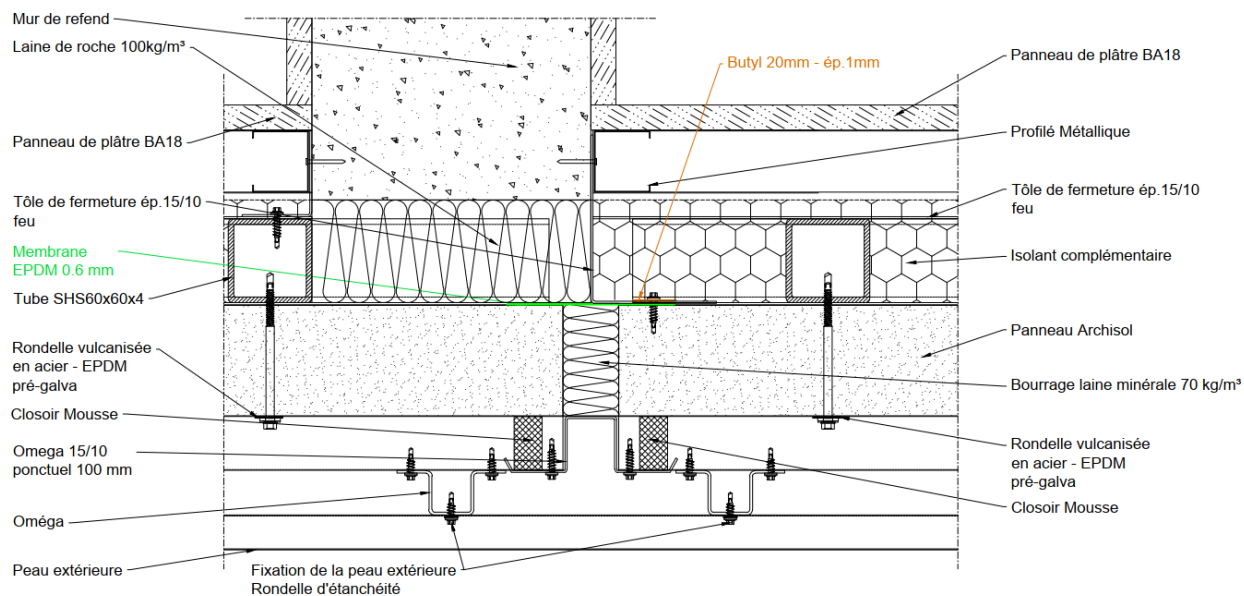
Coupe horizontale sur jonction verticale entre modules D2B –Archisol - Ossature en simple réseau
